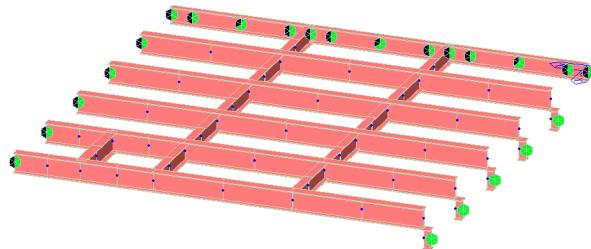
Vincoli applicati al modello a elementi finiti della struttura (support)
